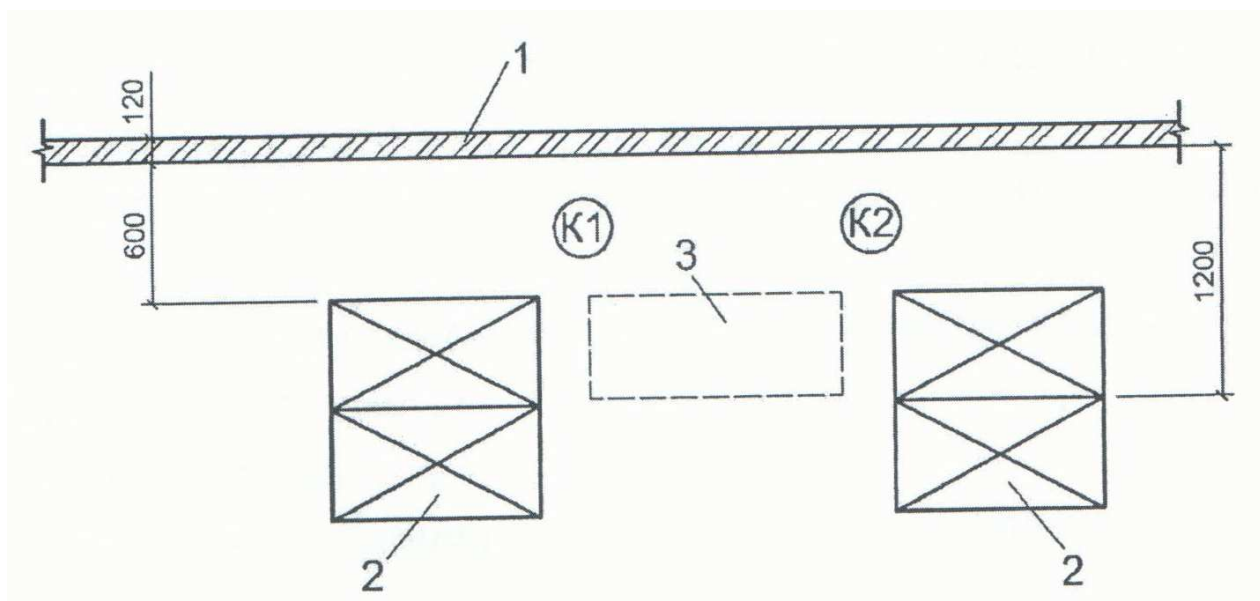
Схема организации рабочих мест при устройстве перегородок с уровня перекрытия
